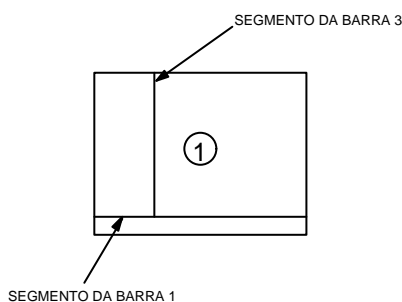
Segmentos de barras no interior do elemento de concreto
